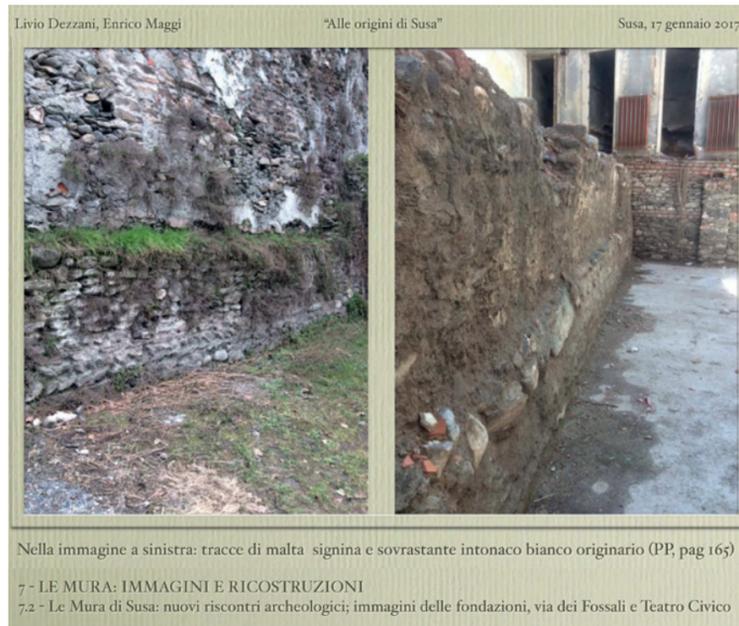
Le foto mostrano i particolari della struttura di fondazione, sul lato interno delle Mura Sud, nel cortile di Casa Calzanera (a sinistra) e nel cantiere per il recupero del Teatro Civico (a destra): appare evidente la risega, nel punto in cui parte il muro in elevato.
